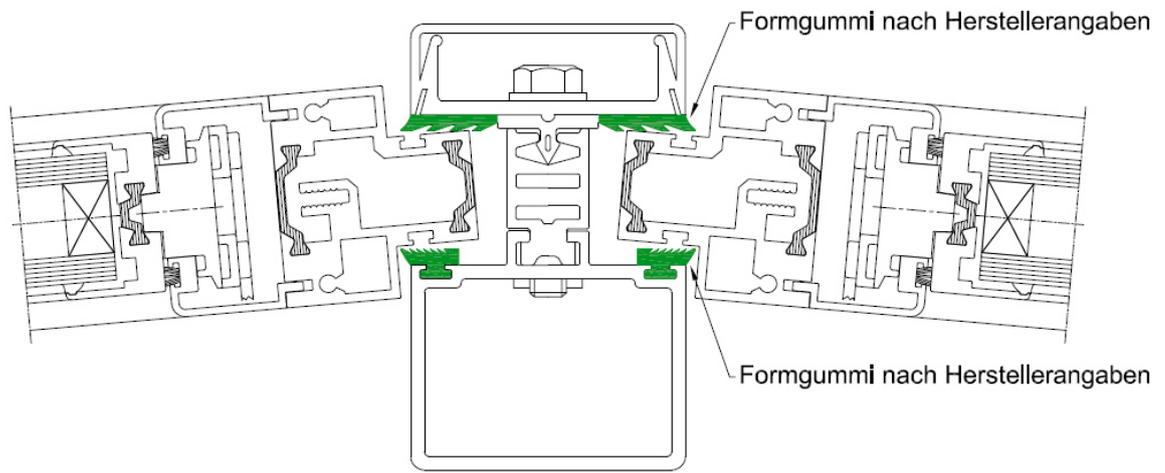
Polygonaler Einbau in Fassadenkonstruktionen
